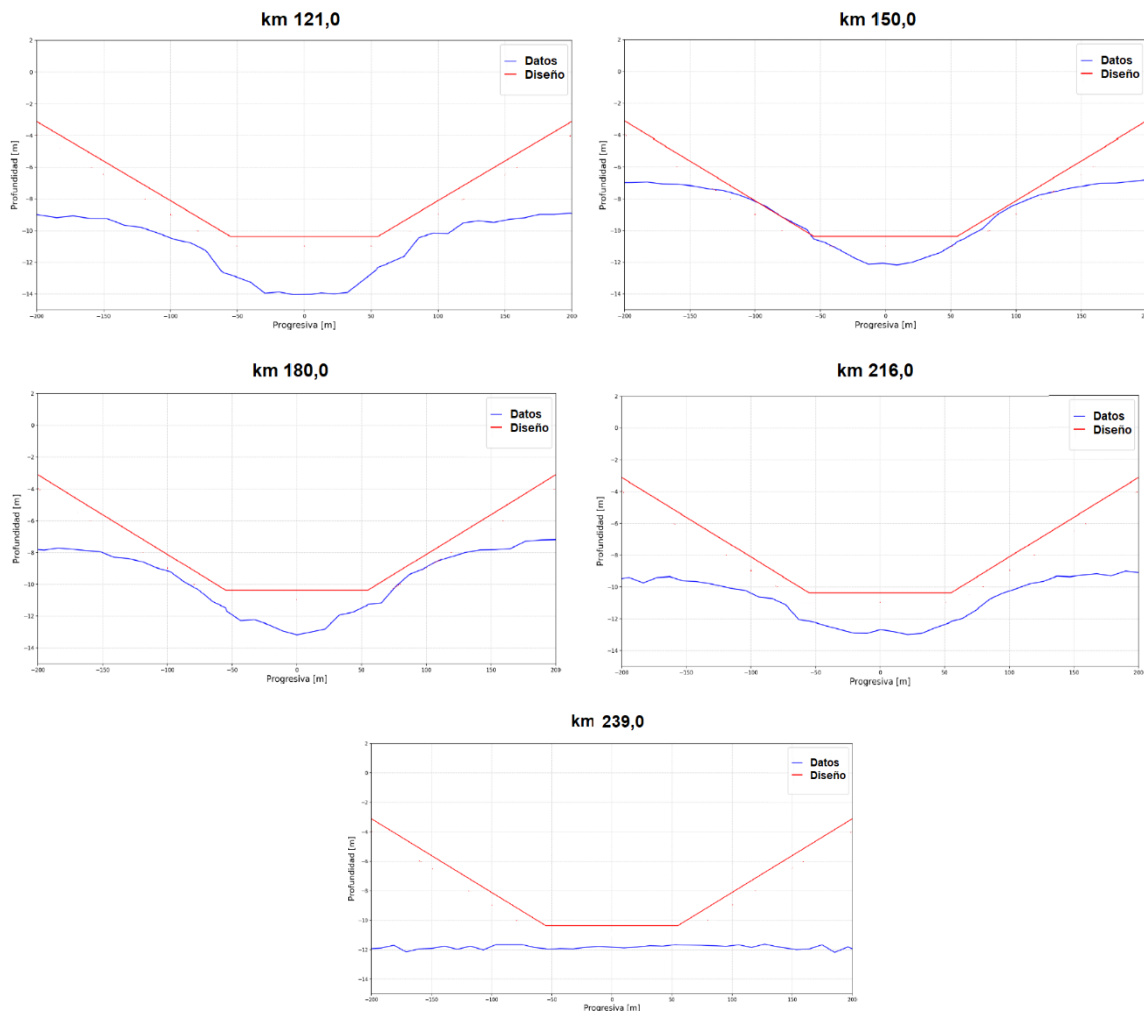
Selección de perfiles transversales a lo largo del canal Punta Indio. Fuente: elaboración propia en base a batimetrías.
